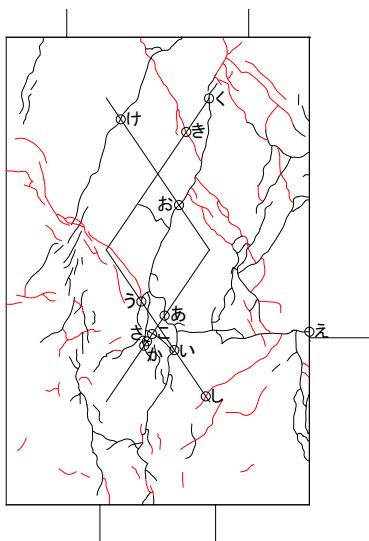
3. 322 パイルキャップひび割れ幅測定位置(試験体 A-7b 負荷荷)
